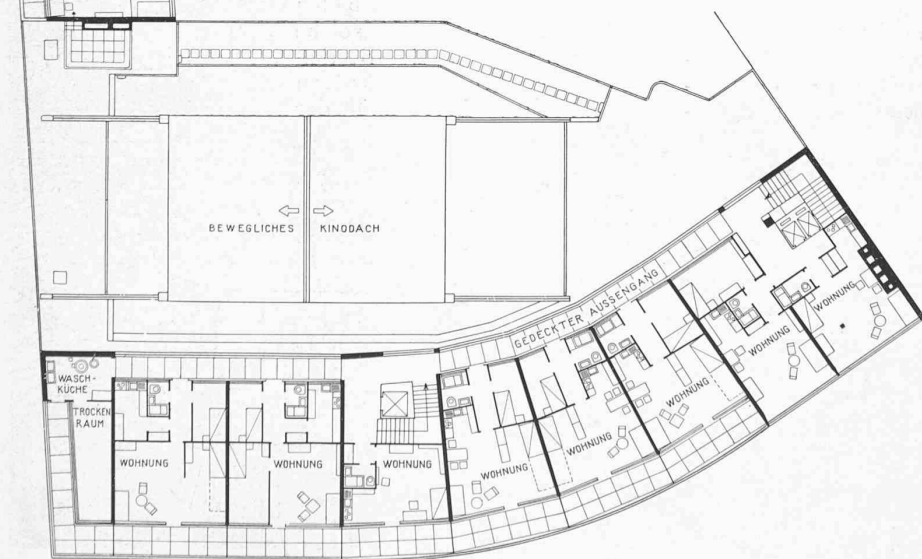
Grundriss vom Wohnungs-Geschoss mit gedecktem Aussengang. — 1 : 40.
